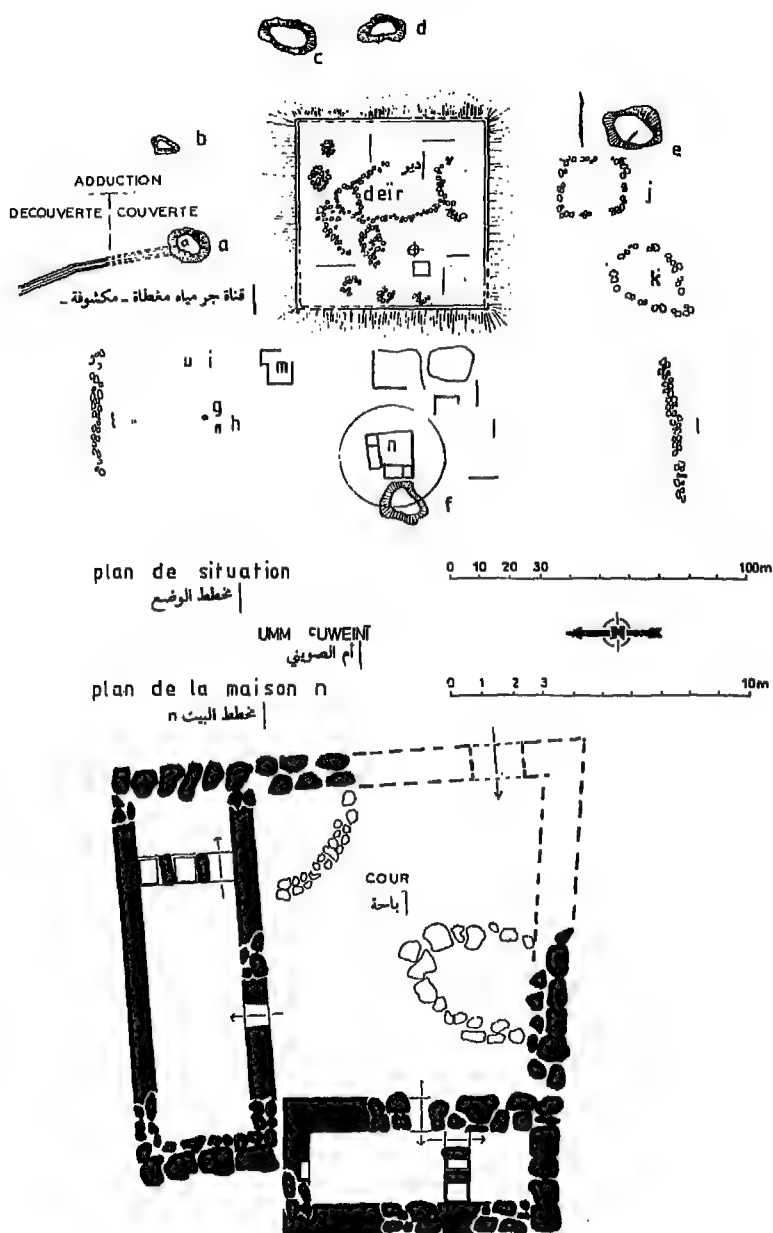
Umm 'Uweinat, plan d'ensemble et plan de l'une des maisons.
